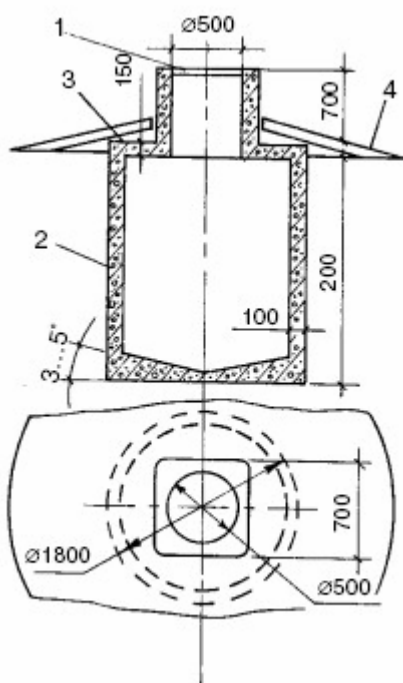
Подземный резервуар: 1 – кольцо (сталь); 2 – стакан (железобетон); 3 – песок; 4 – отстойка (бетон)
